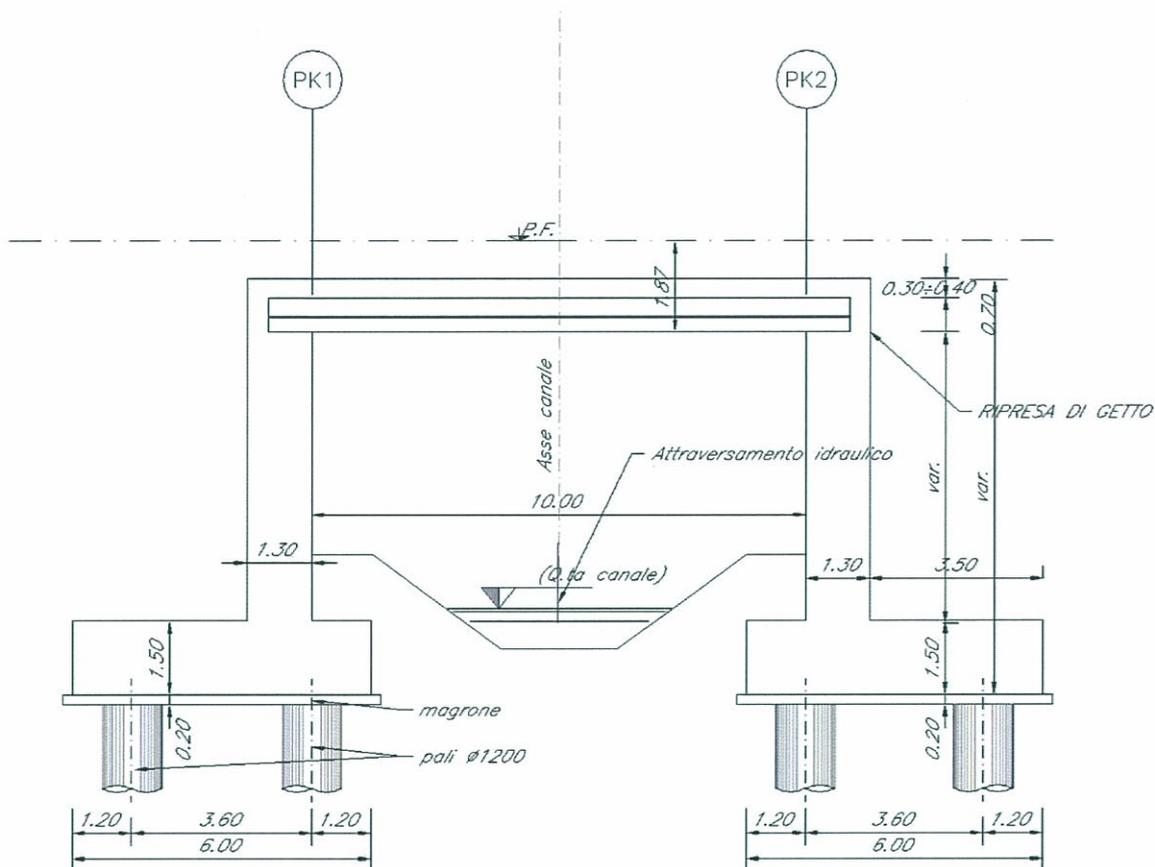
Prospetto in corrispondenza di attraversamento idraulico.
